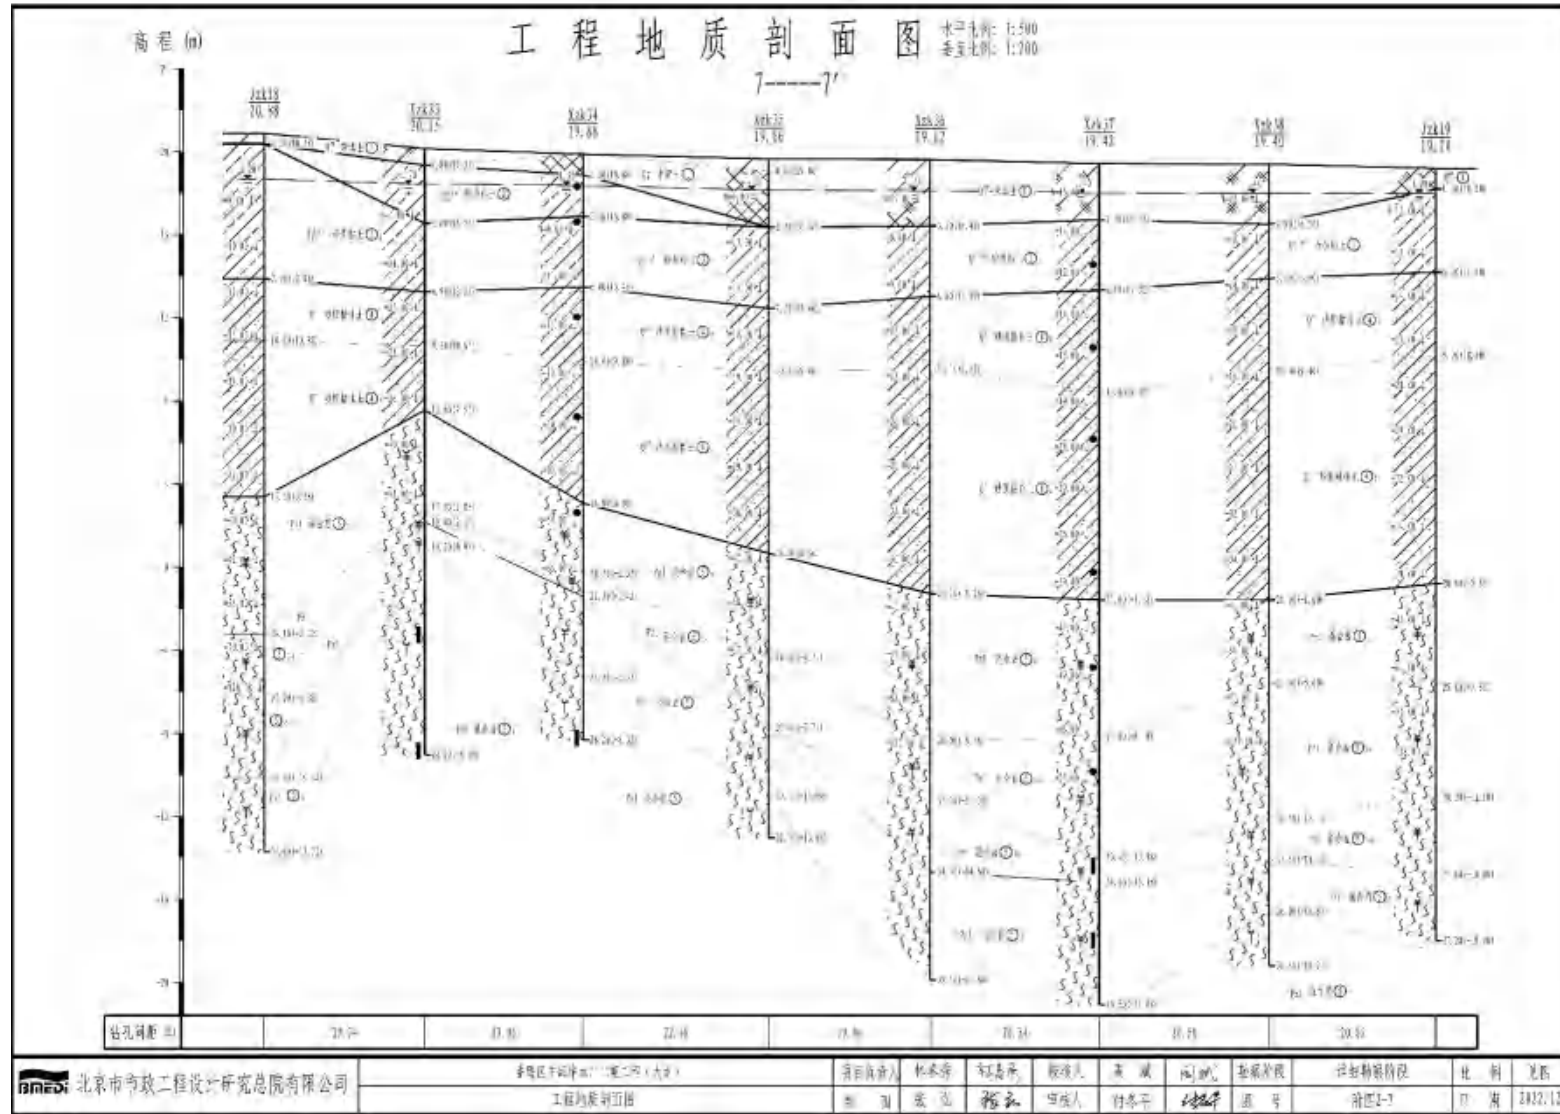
场地部分工程地质剖面图（7-7'）
